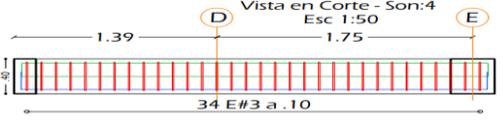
Despiece de viga secundaria 412 plano estructural Edificio Wiedii
